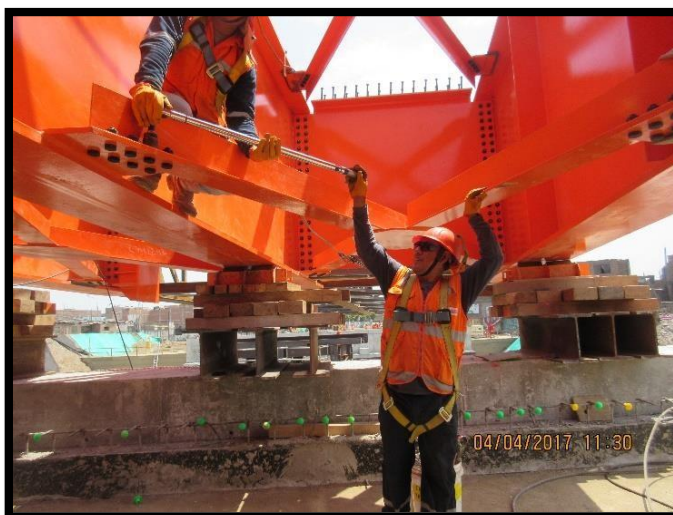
Colocación de pernos para arriostres de vigas metálicas.
